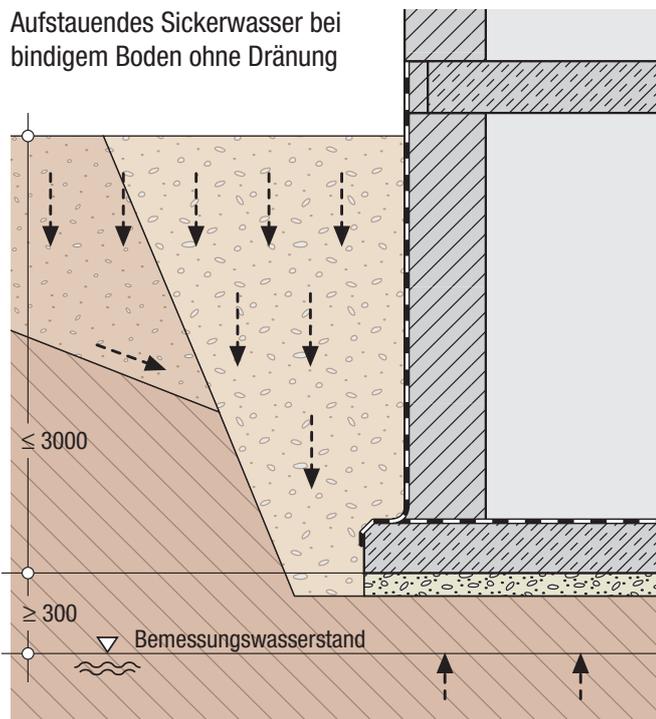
Wasserbeanspruchung erdberührter Bauwerke nach DIN 18 195-4
